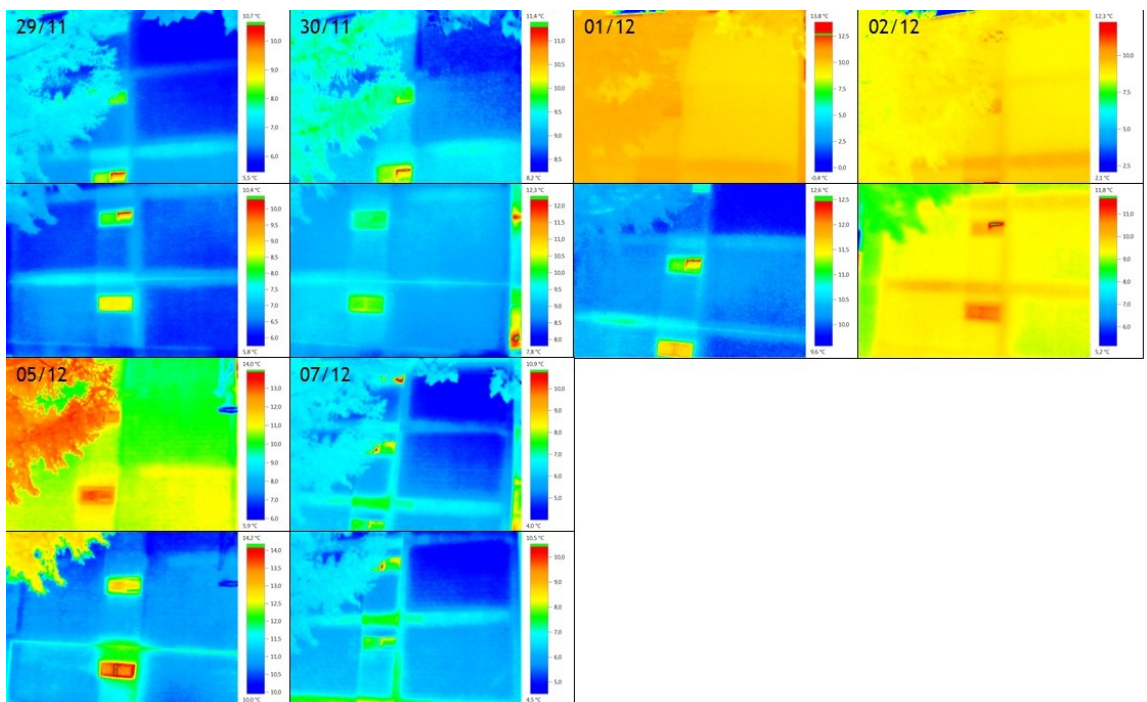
Fachada lateral esquerda - instalações sanitárias
